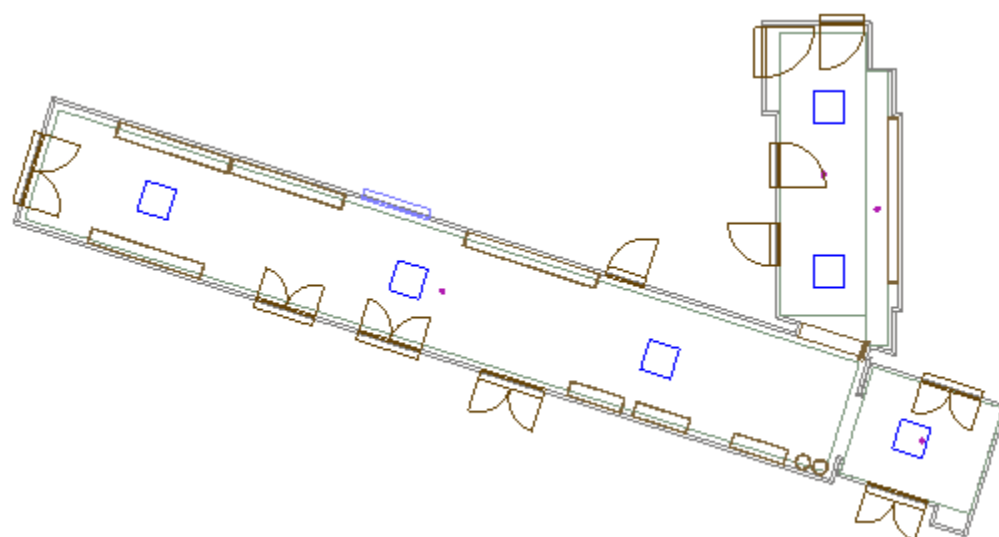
6: Corridoio (Area 15 e Area 11) – Planimetria
